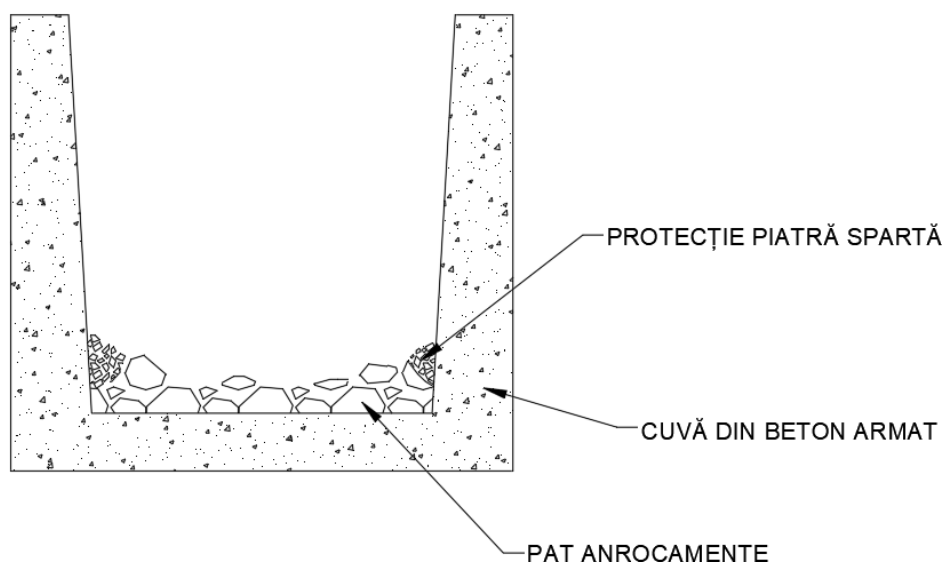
Secțiune canal beton amenajat pentru pasaj
